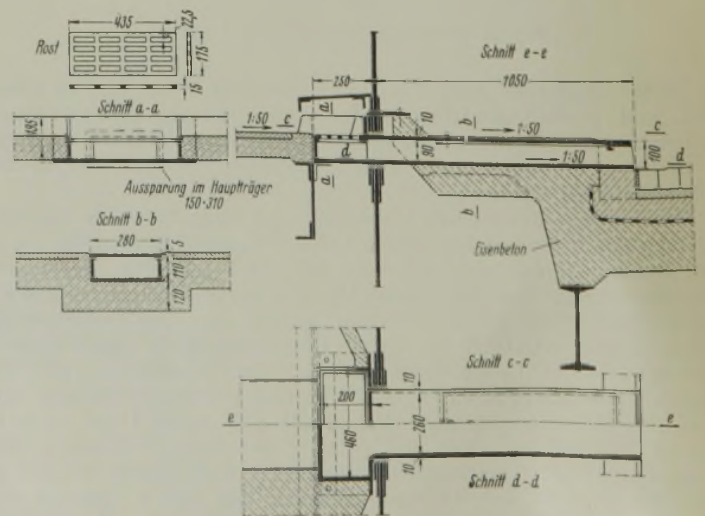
Entwässerung der Gehwege nach den Straßenkandeln,
